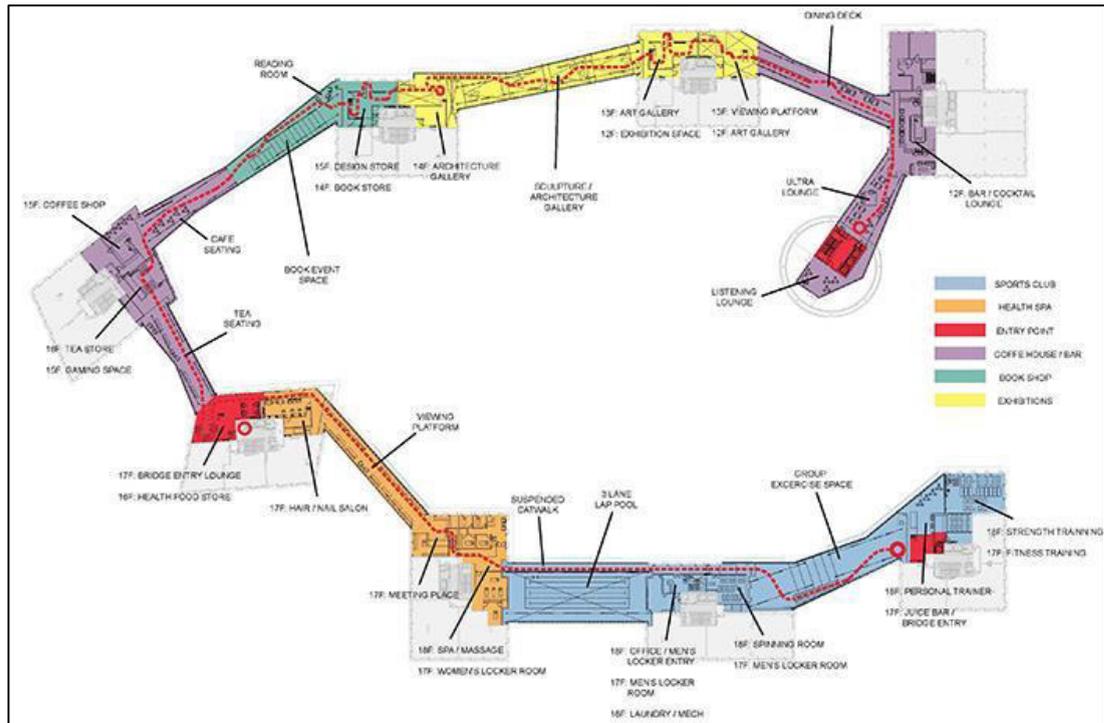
Lynked Hybrid - Planta de zonificación de usos mixtos.
